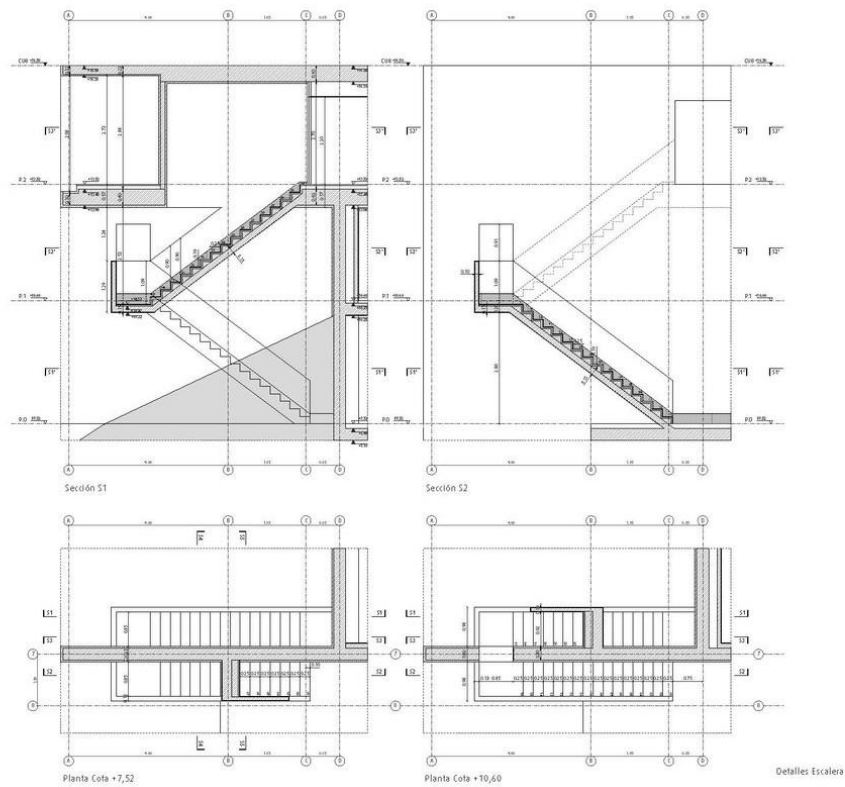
Detalle escalera 02. Fuente: Fran Silvestre Arquitectos.
